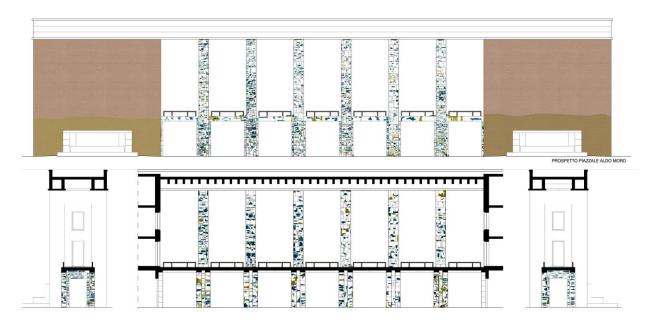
Prospetto e Sezione prospicente Piazzale Aldo Moro
